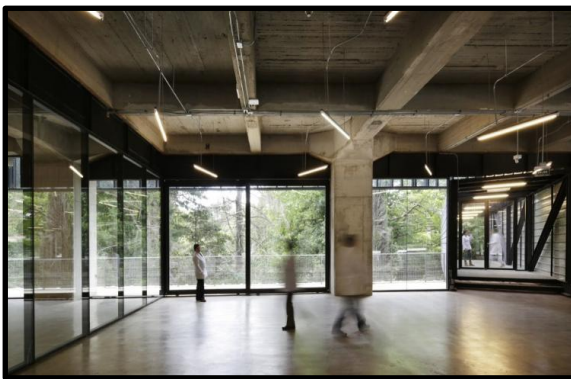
USO DE MARCOS ESTRUCTURALES DE CONCRETO
